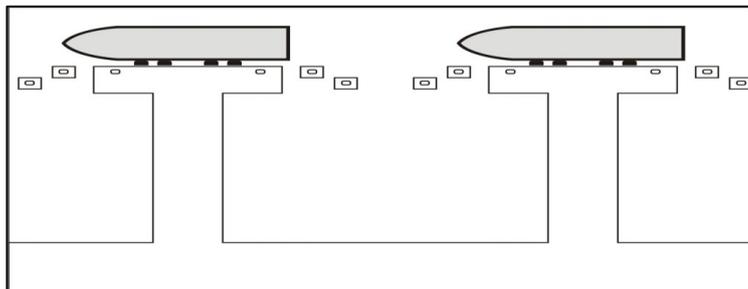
Bentuk Dermaga Jenis Jetty/Pier
